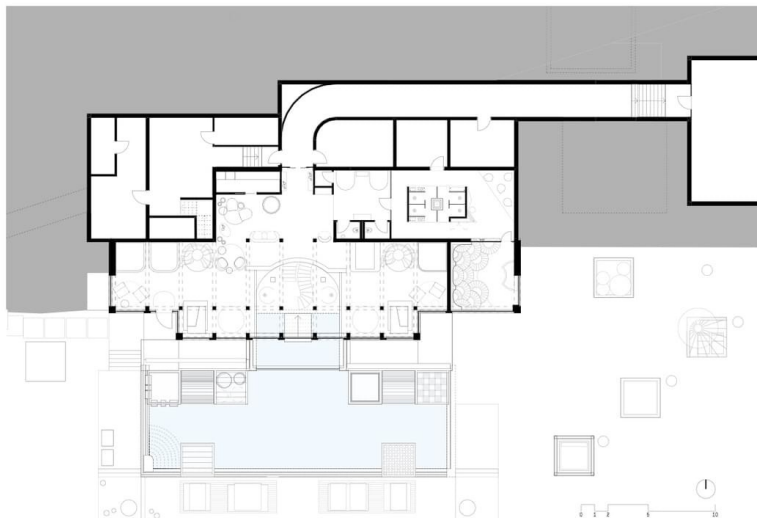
План цокольного этажа SPA-комплекса MOHR escape
